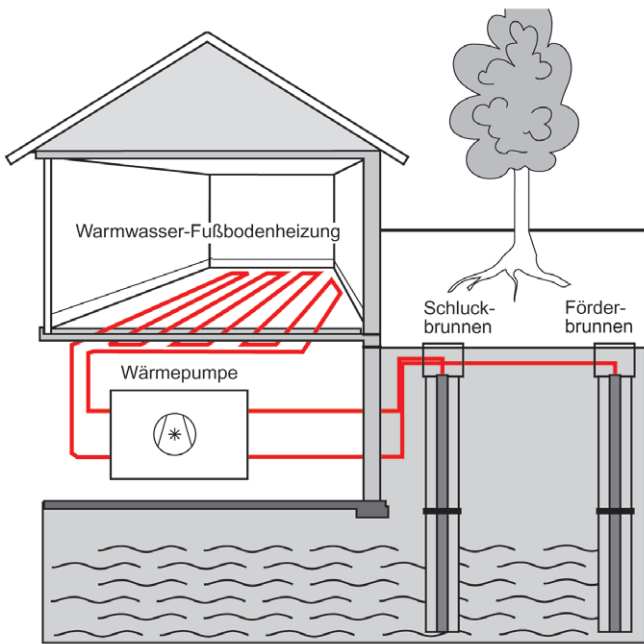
Schema einer Grundwasser-Wärmepumpen-Heizungsanlage
